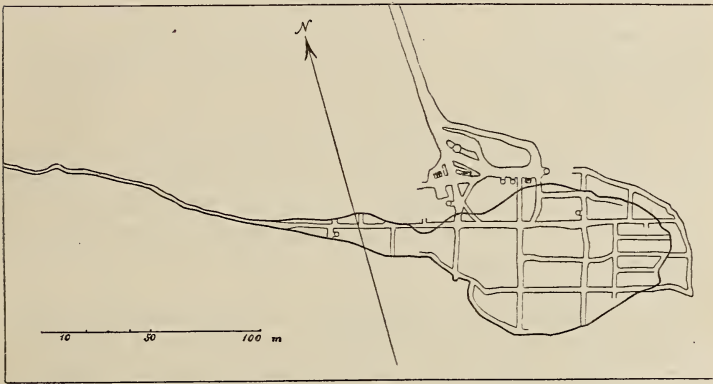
Grundriß der Kimberley Pipe in 648 m Tiefe.
